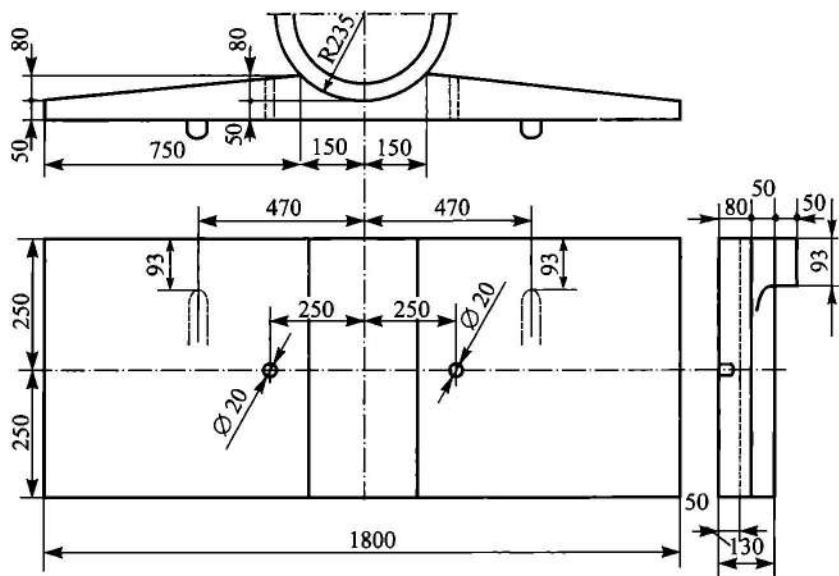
Лежни для конических железобетонных опор типа II
